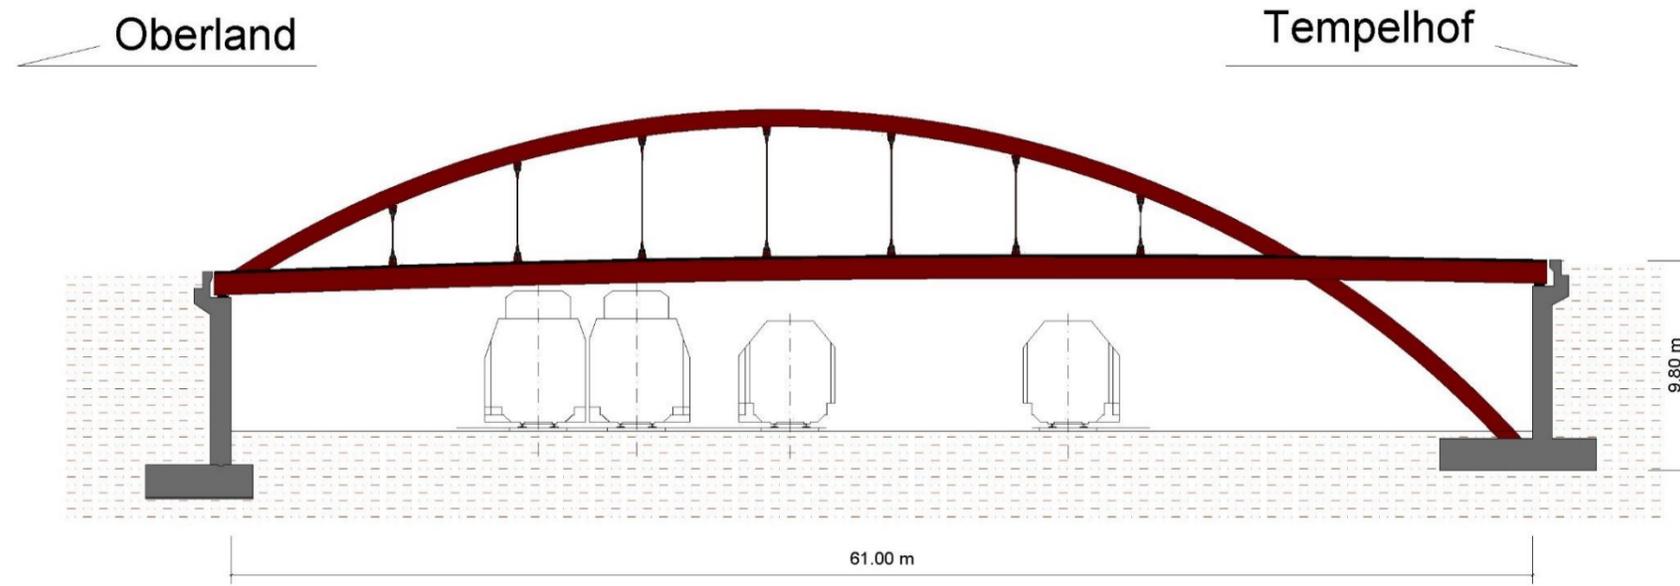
Alzado alternativa 1. Arco con tablero intermedio
